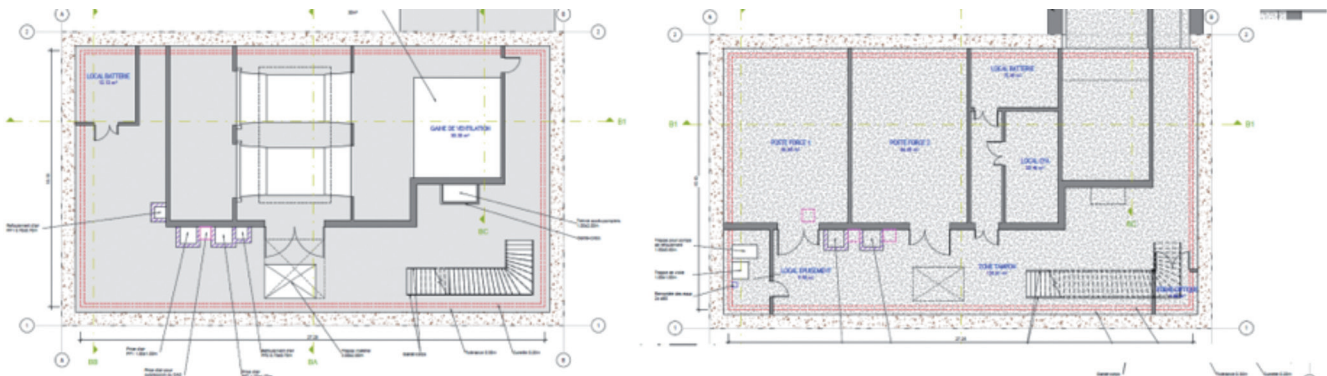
Vues en plan de plusieurs niveaux d'un puits type 8
